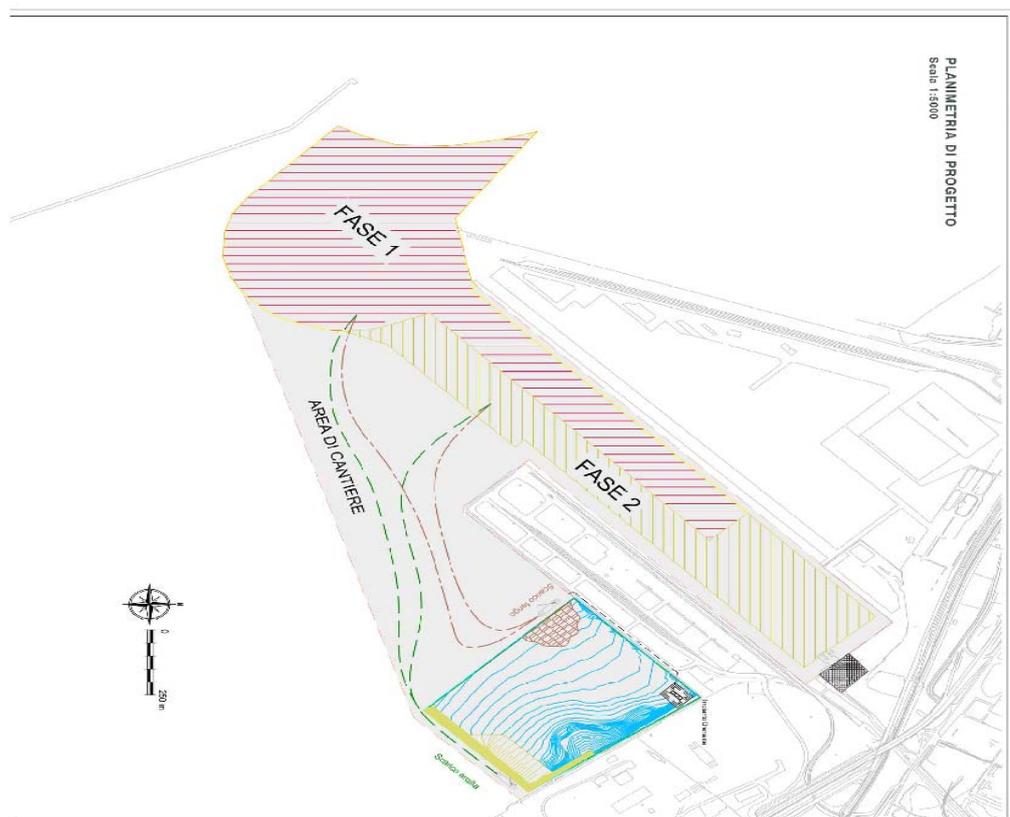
Suddivisione area di dragaggio- Fase 1-2 (ved. tav.254)
